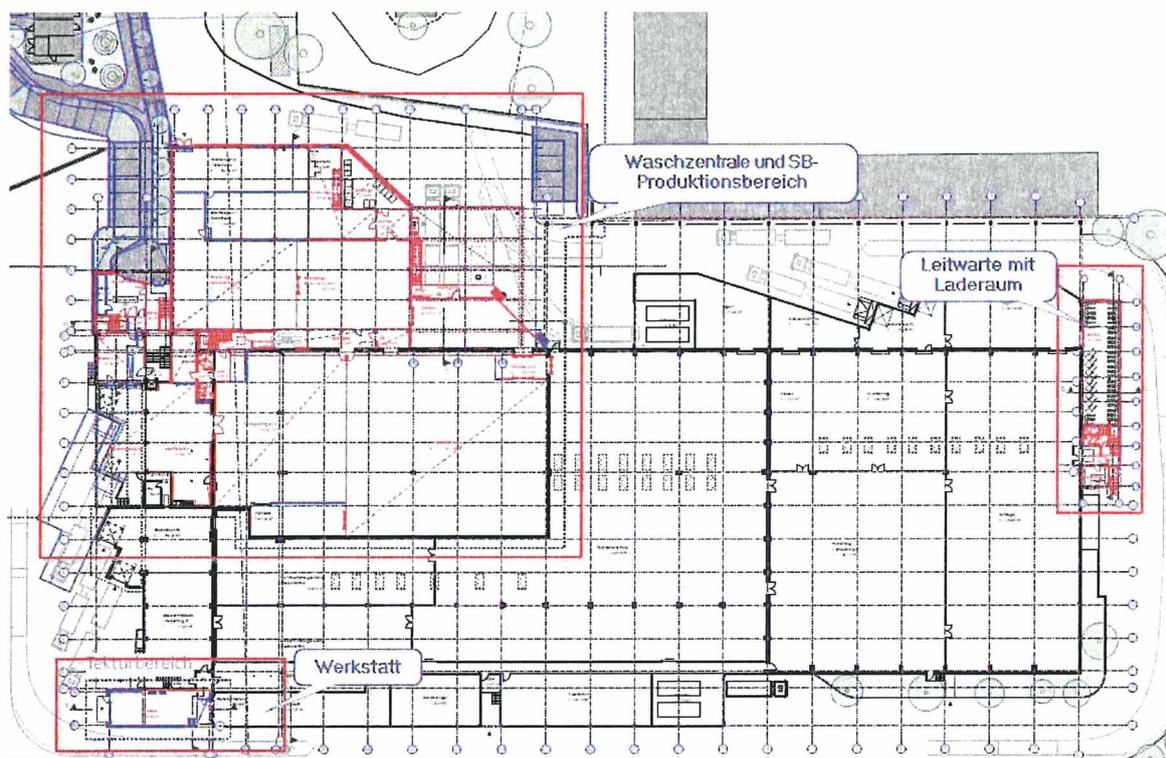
Gebäudegrundriss der BayernFleisch GmbH nach Umbau - Planstand 21.06.2021. Die neuen Gebäudeteile sind mit roten Kästen markiert.
